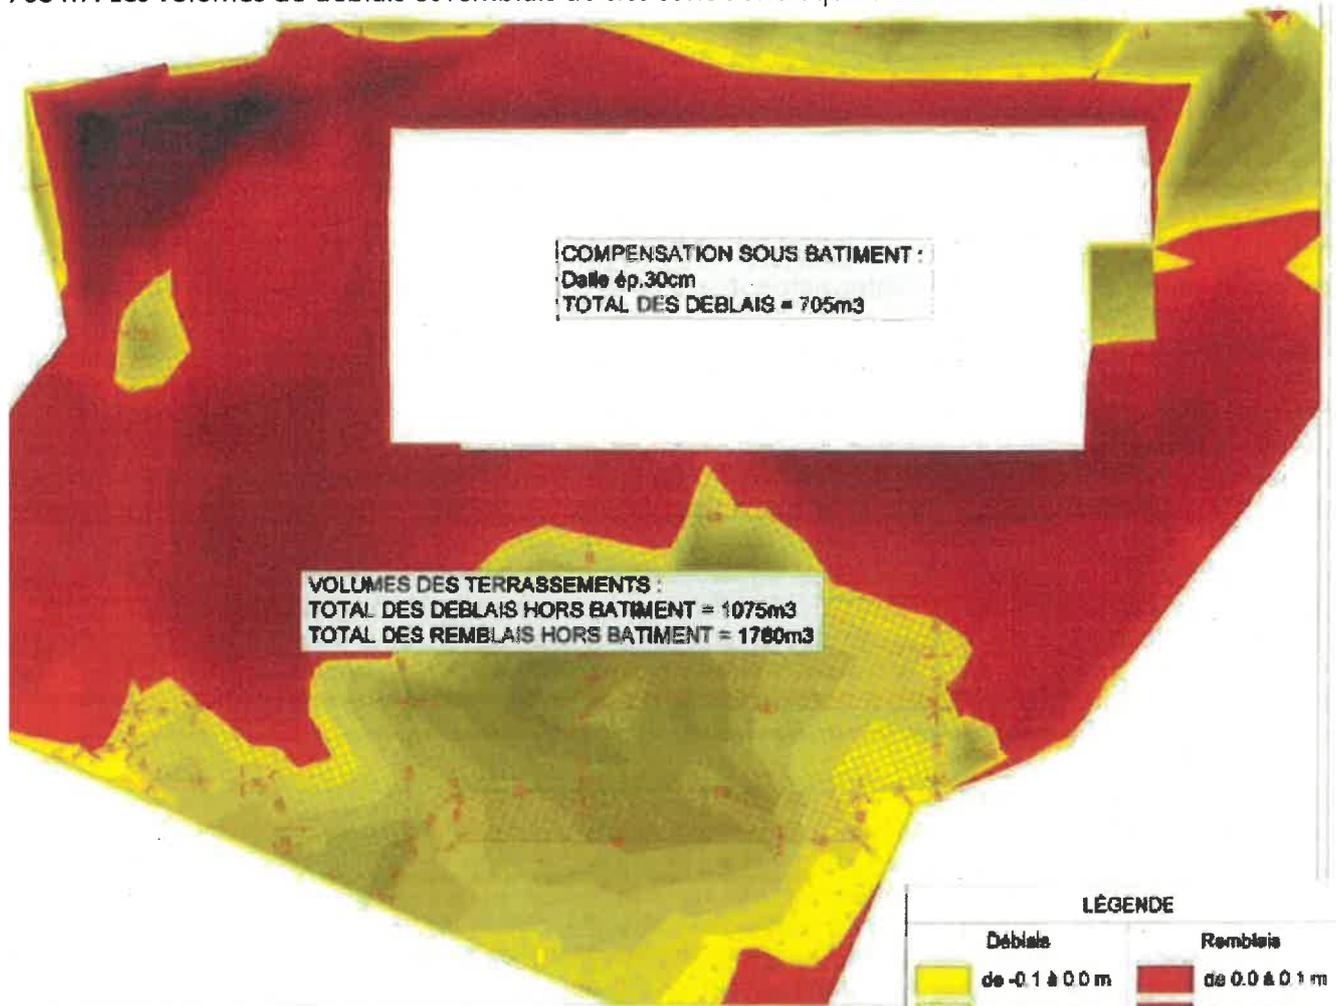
PLAN DE TERRASSEMENT (BERIM)
